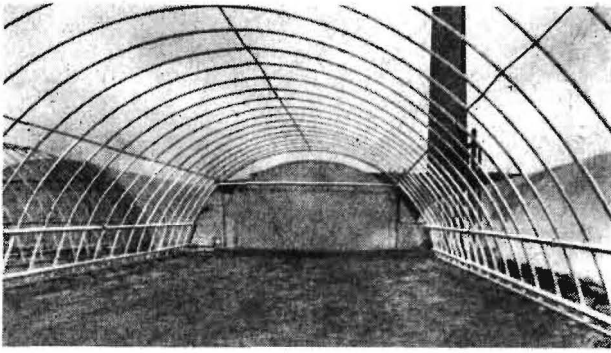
Stahlkonstruktion des FGH 9 × 48 m
